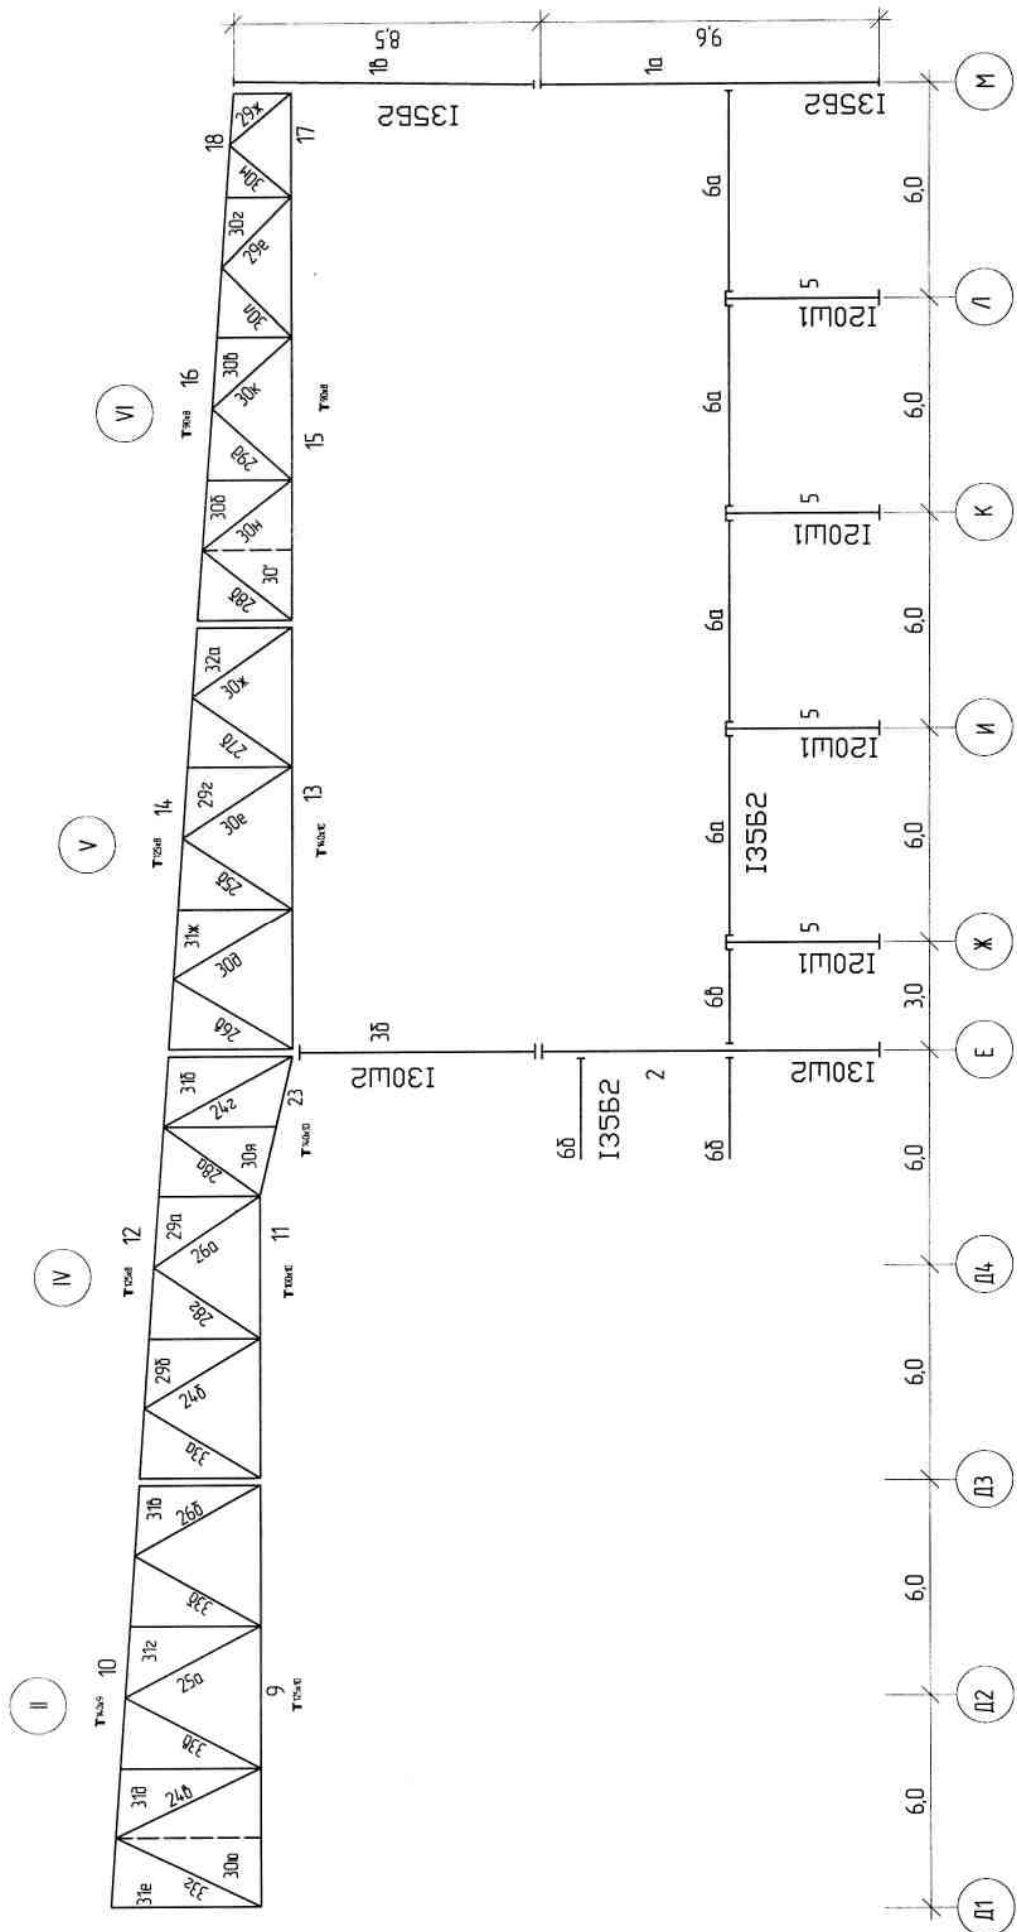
Монтажная схема элементов поперечной рамы каркаса – правая половина
